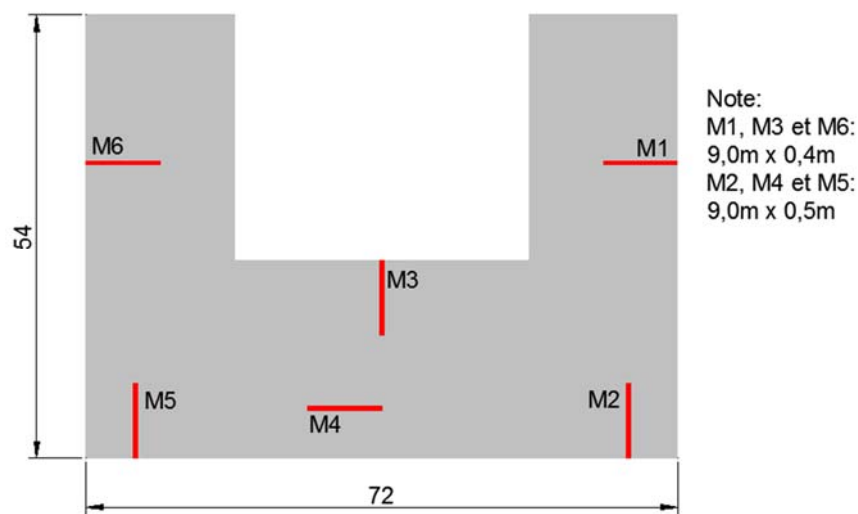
Vue en plan du bâtiment et position des murs de refend
